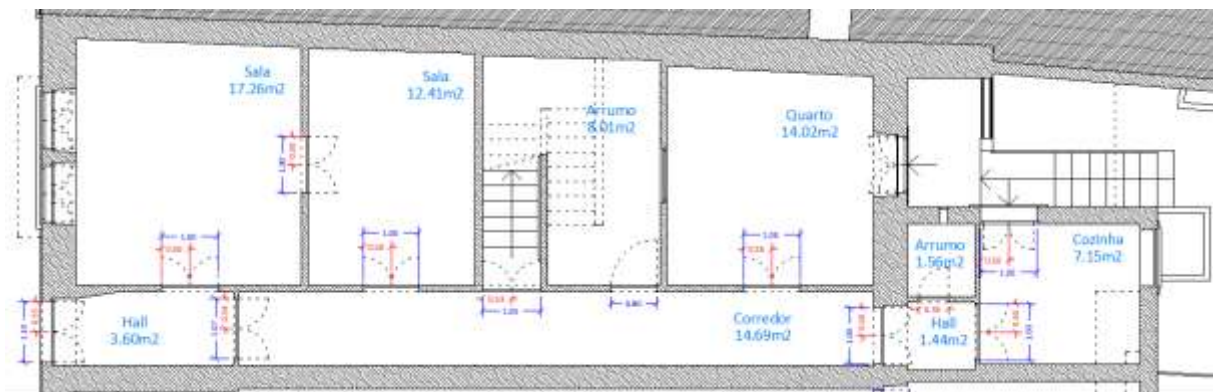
Dimensões em planta para a verificação dos vãos das portas do piso 1 (SRU, 2023).
